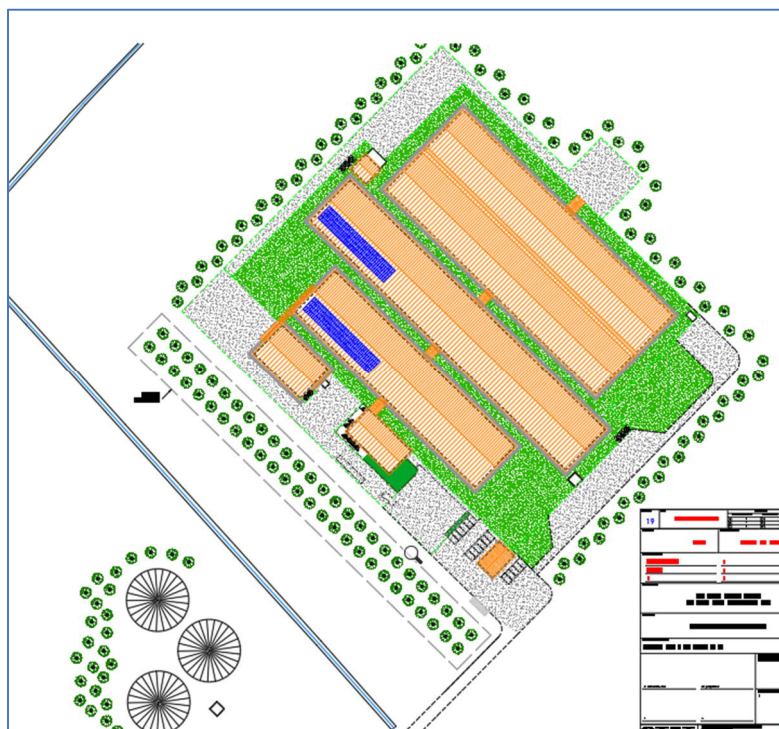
Planimetria sito – progetto del verde e tabella essenze previste
